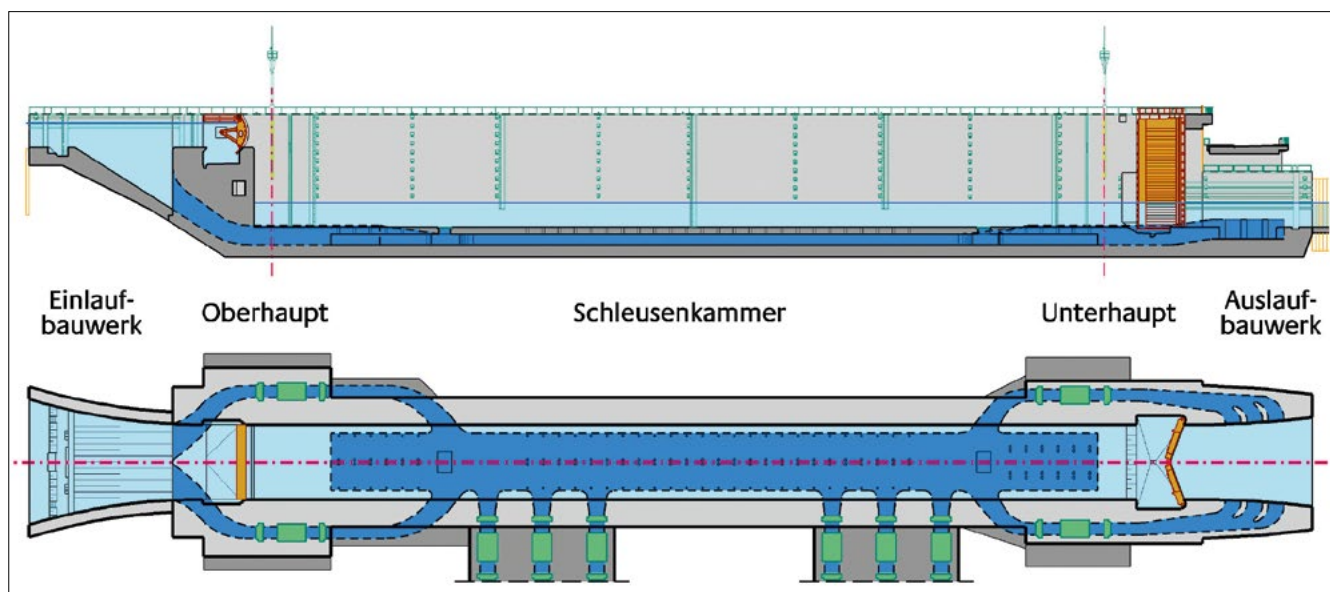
Schleusenansicht und -draufsicht mit Grundlauf und Zulaufkanälen (dunkelblau)
